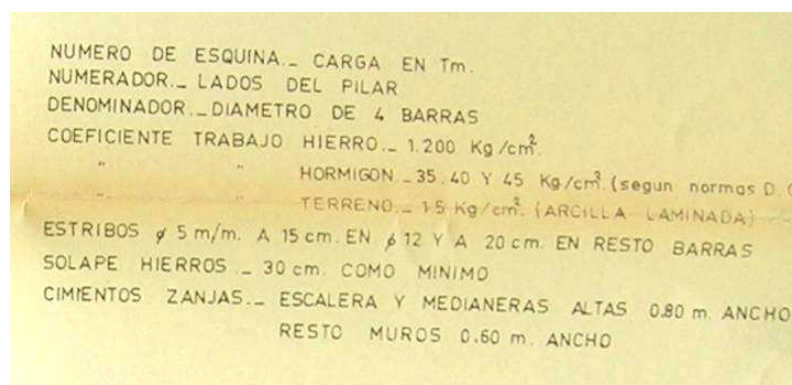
Leyenda del cuadro de pilares. Edificio ficha 2191C.006, 1971
